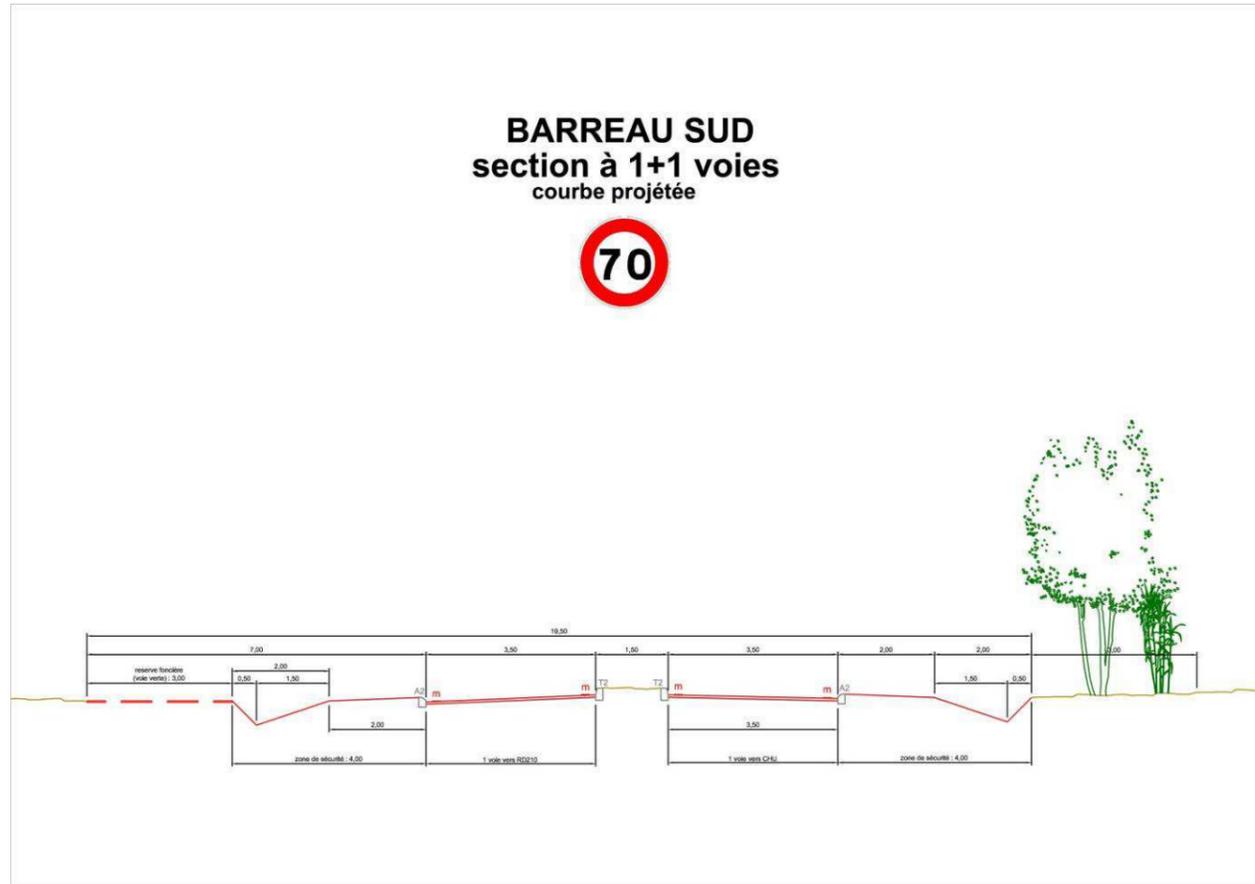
Profil en travers type du Barreau Sud sur la section à 1 + 1 voies
